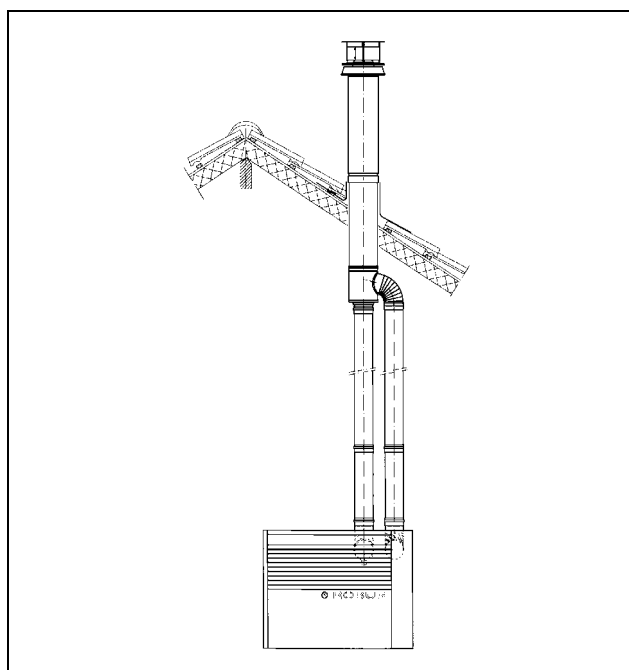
INSTALLAZIONE TIPO C32 CON CONDOTTO COASSIALE A TETTO
